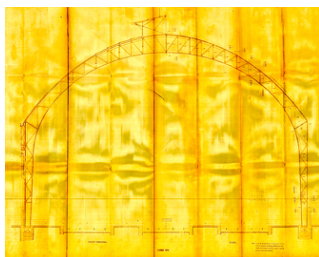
Sección plano original cubierta Valencia. Fuente: AHF, I-0046-001.
